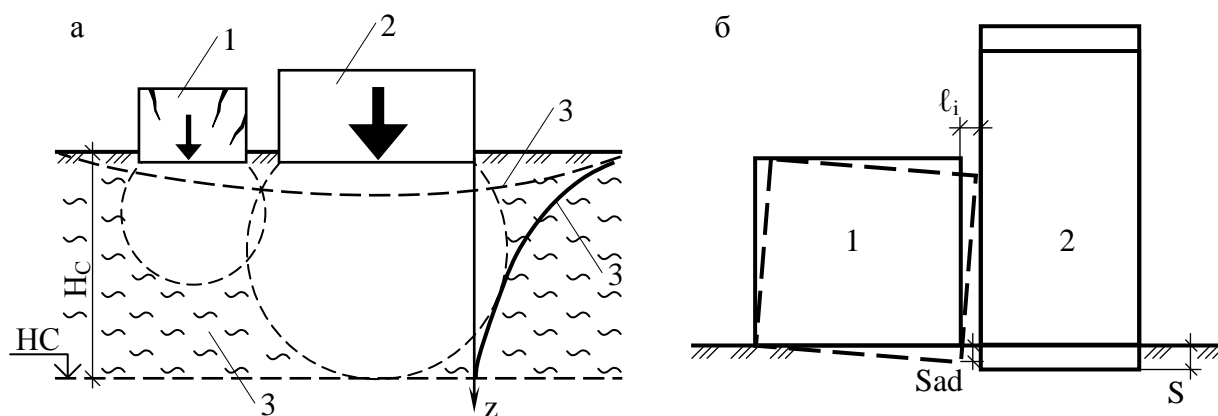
Осідання поверхні ґрунту (а) та характер деформації різнонавантажених будівель (б), що розміщені поблизу одна від одної: 1 – існуюча будівля; 2 – будівля, що зводиться; 3 – вирва осідання; 4 – епюра осідання поверхні ґрунту; 5 – стискувана товща
